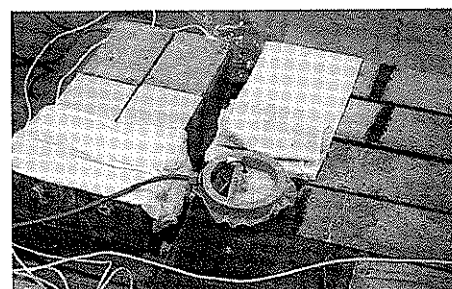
ひび割れ供試体の自然電位の測定状況
